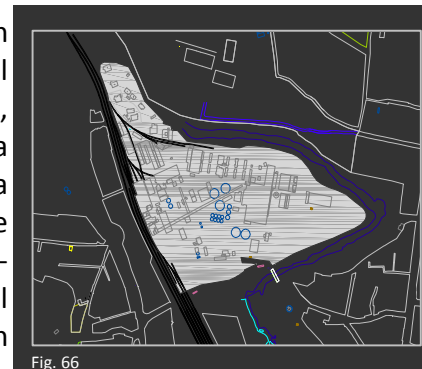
Plano de conjunto de la antigua planta de cementos “La Tolteca” ubicada en Tula Hidalgo.
